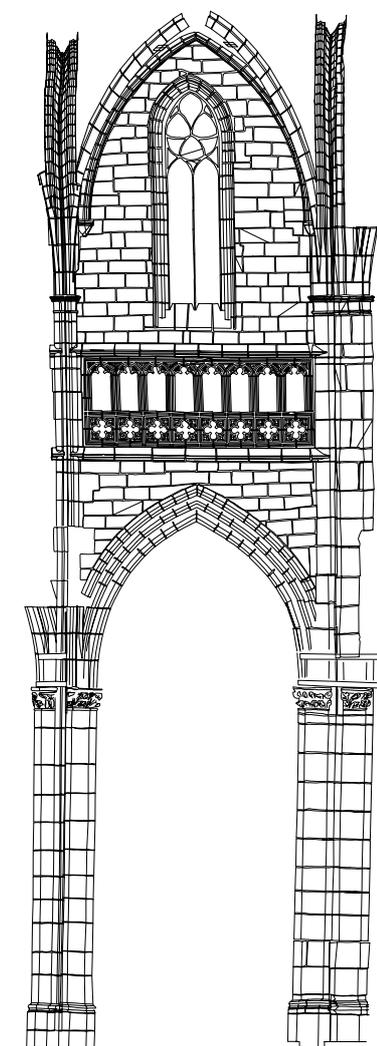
Clave tipológica. Tramo de la sección interior de la Catedral donde se asocian sus elementos constructivos, pilar, pilastra, arco diafragma, triforio, ventanal, arco perpiáño, arco fornero
